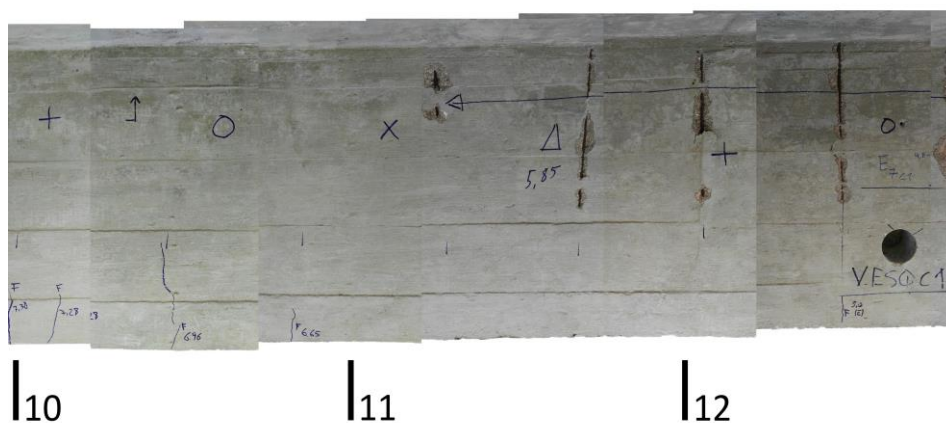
Foto da viga esquerda entre os 10 e 12,5 metros
